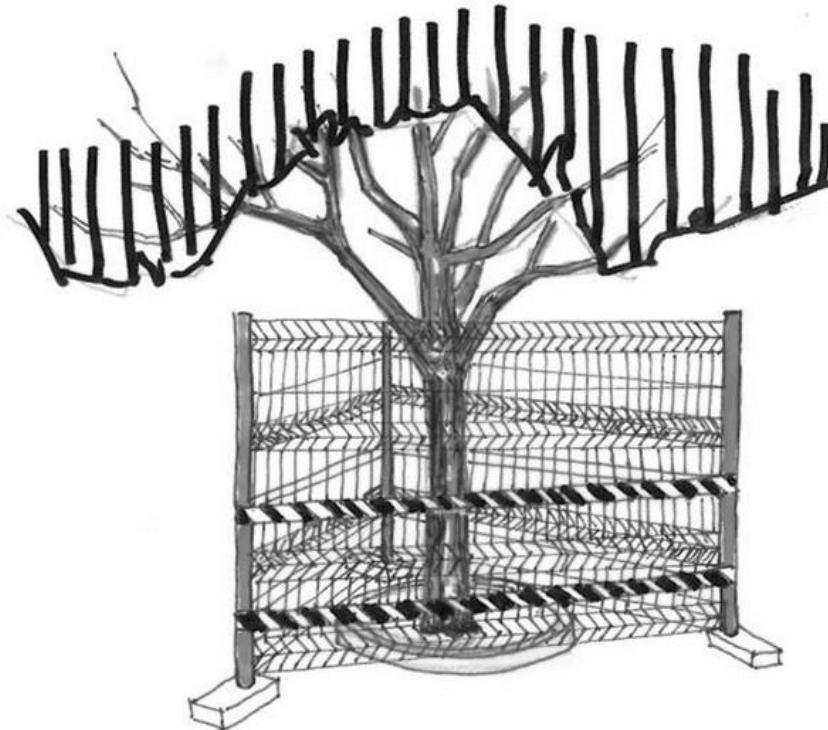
Exemplo de colocação de barreiras para proteção do tronco no decurso de obras: estrutura para proteção de árvore com cercas móveis de 3,50x2,00 m, constituídas por painéis de malha electro soldada e postes verticais, acabamento galvanizado, colocados sobre bases pré-fabricadas de betão.
